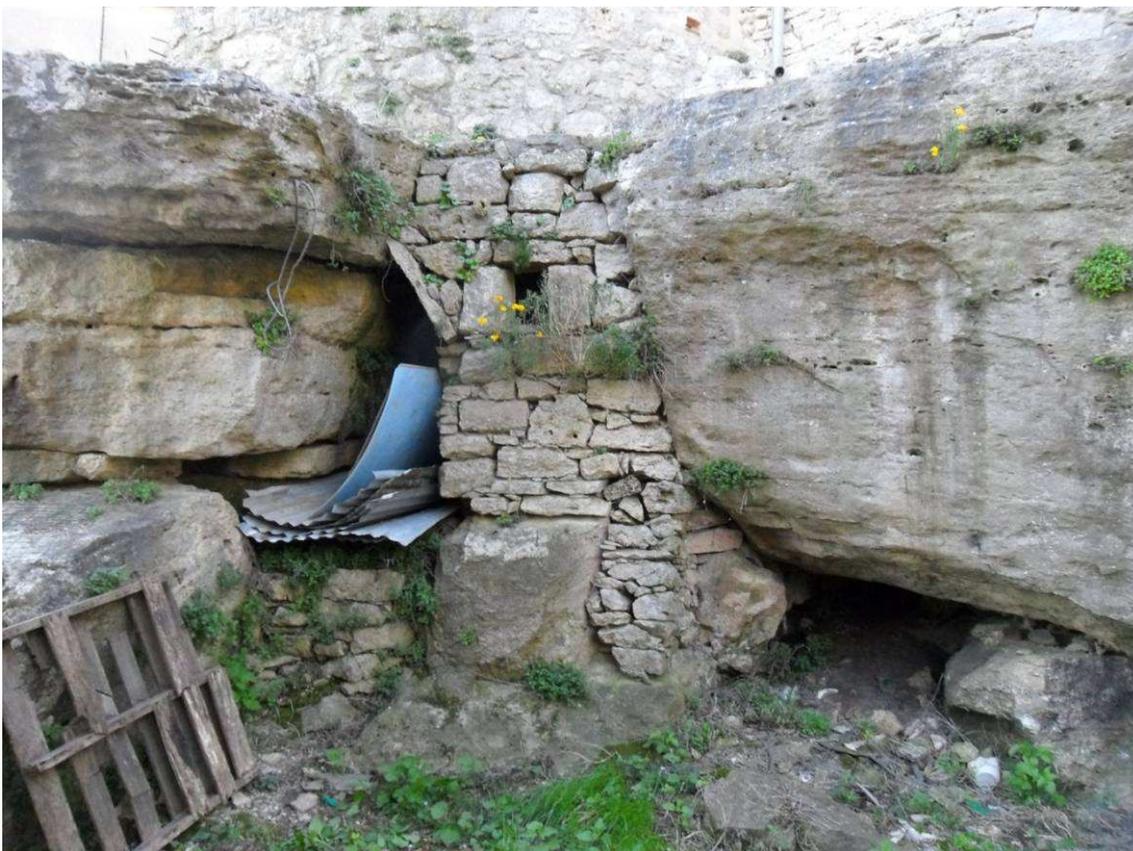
Muratura esistente da ripristinare e masso da sottofondare
